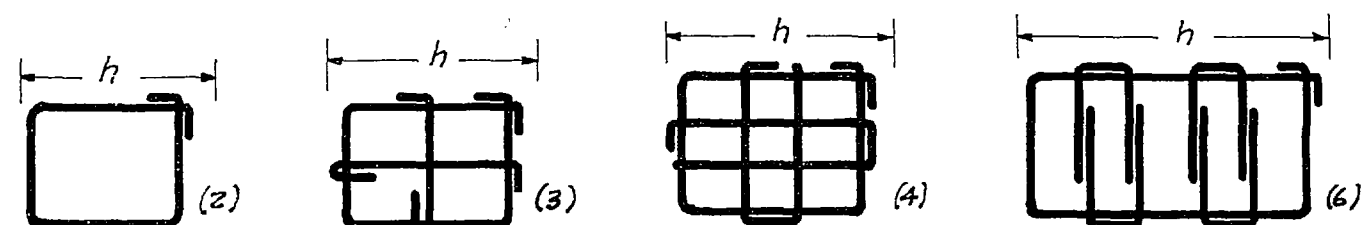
AMARRE UNIVERSAL DE COLUMNA, APLICABLE PARA CADA RETICULADO PREARMADO O ARMADO EN SITIO.
